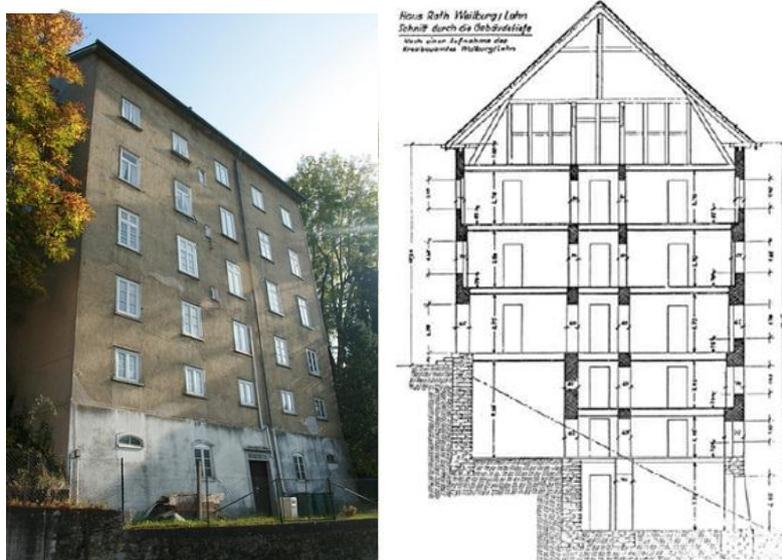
Un bâtiment de 6 étages en pisé construit en 1820 en Allemagne. (Walker, P et al, 2005)
